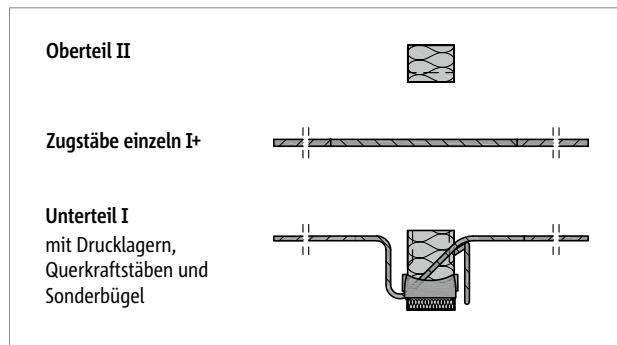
Schöck Isokorb® RT Typ K: Produktschnitt
